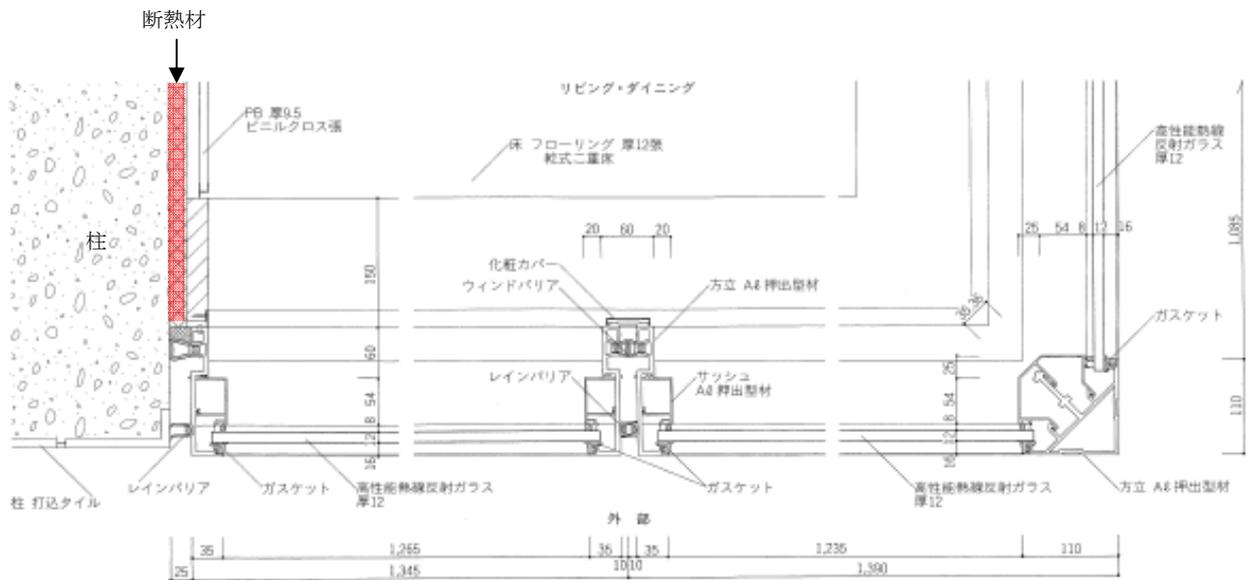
TOKYO TIMES TOWER図面（平面詳細）
